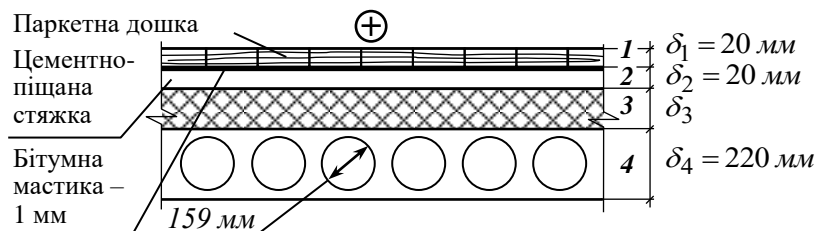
Розрахункова схема конструкції перекриття над підвалом
